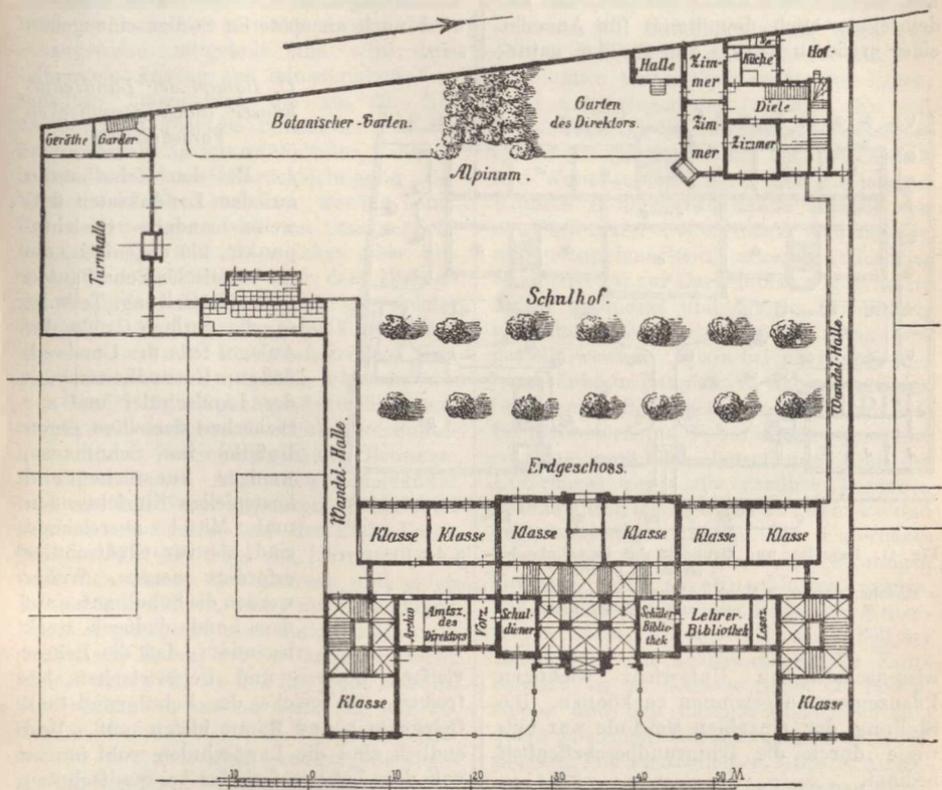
Lageplan und Grundriß des Bismarckgymnasiums in Dt. Wilmersdorf (s. S. 600).
